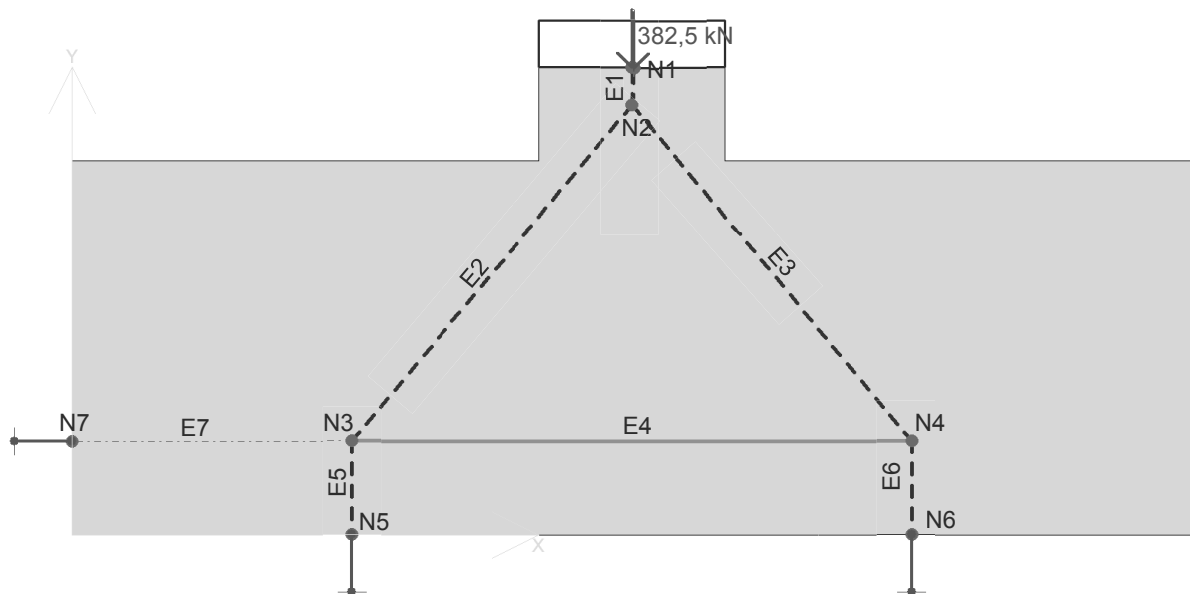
Modelo de bielas e tirantes para bloco com pilar centrado.
